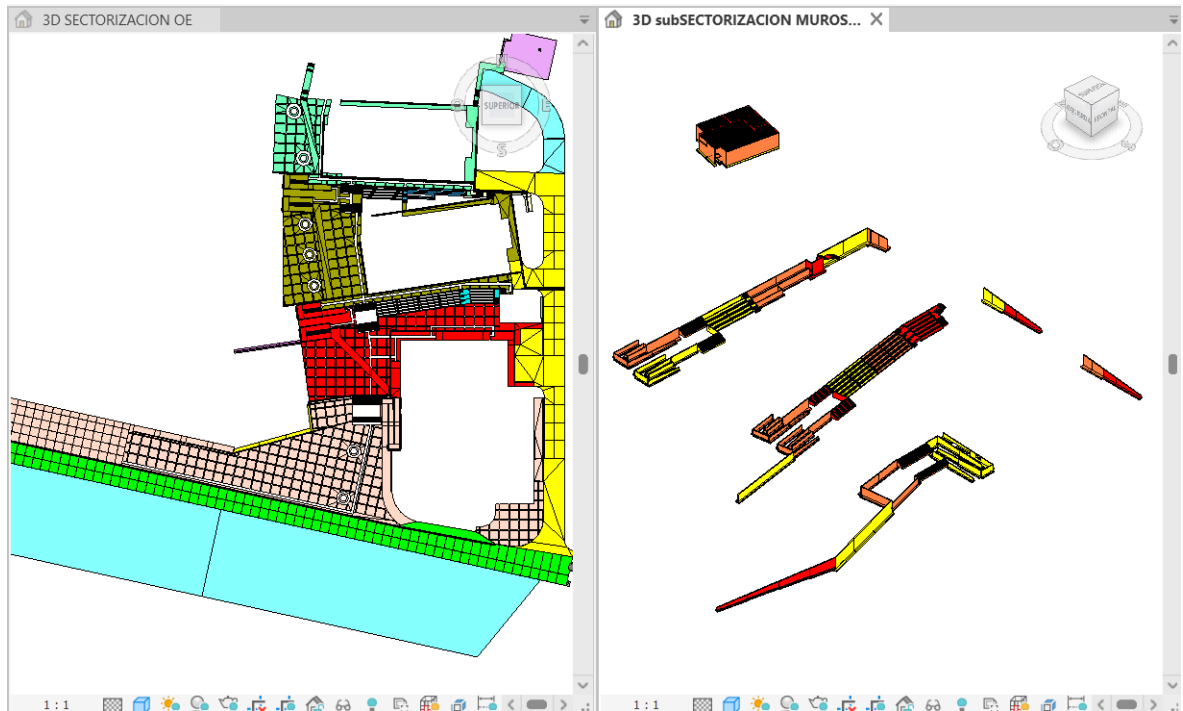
Sectorización de las Obras Exteriores (Pavimentos y Muros de Contención)
